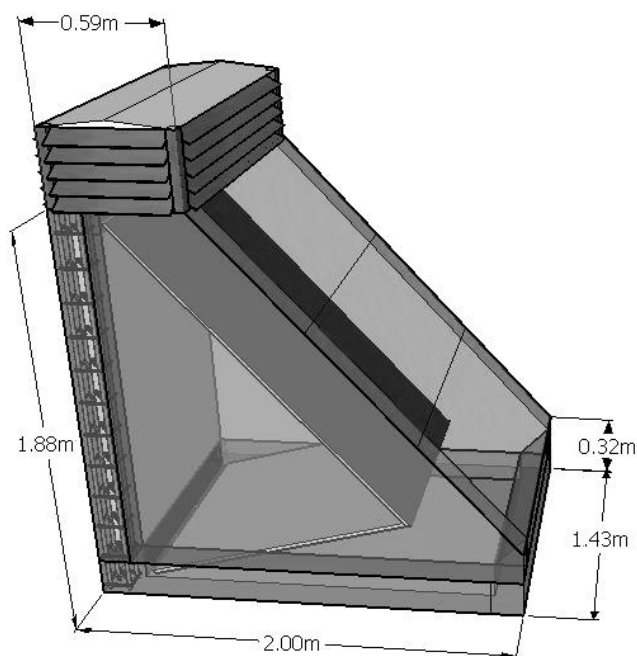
Plano de fachada arquitectónica sur de chimenea solar. Fuente: propia
